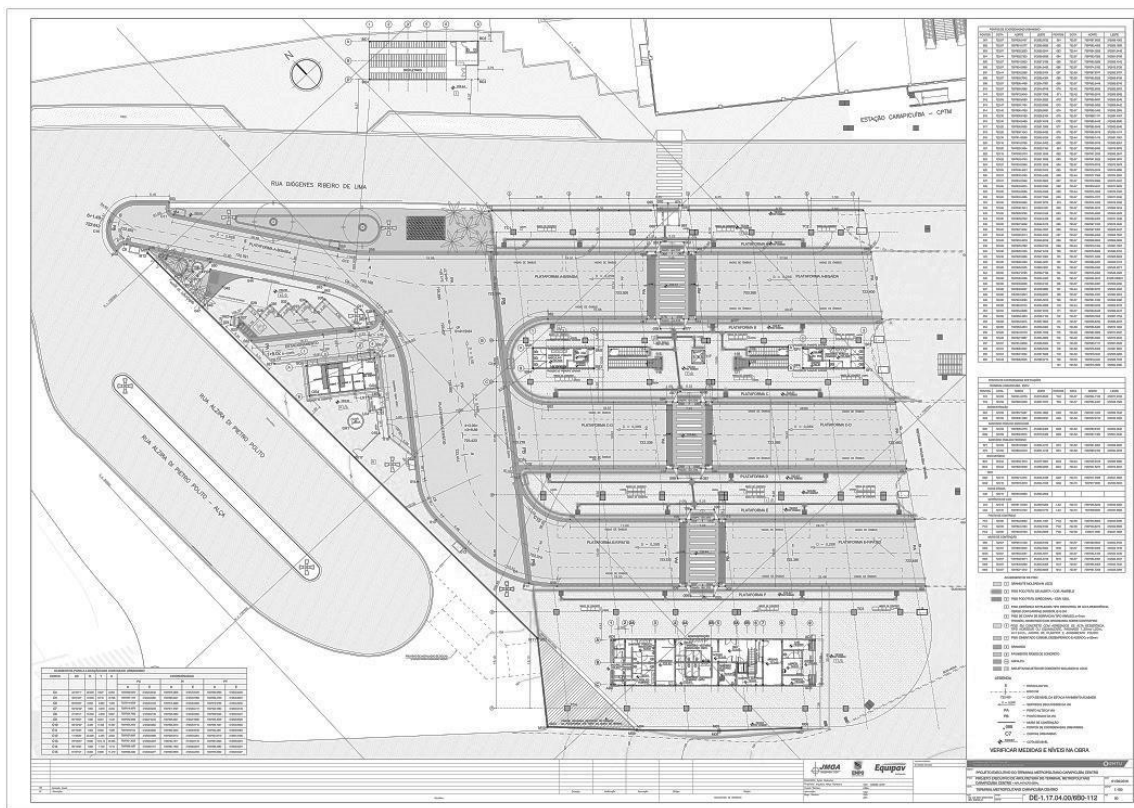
Planta Terminal Metropolitano Carapicuíba
